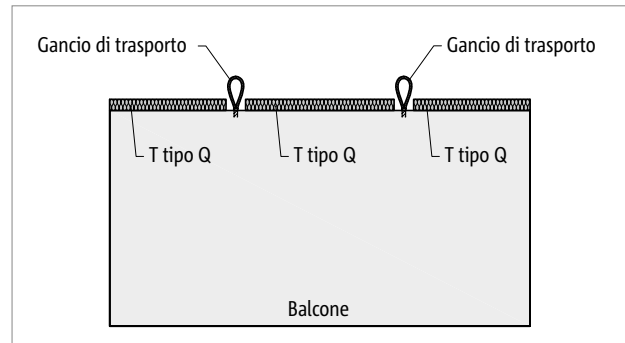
Schöck Isokorb® T tipo Q: elemento balcone con gancio di trasporto; il pezzo isolante intermedio T tipo Z può essere posato in opera
